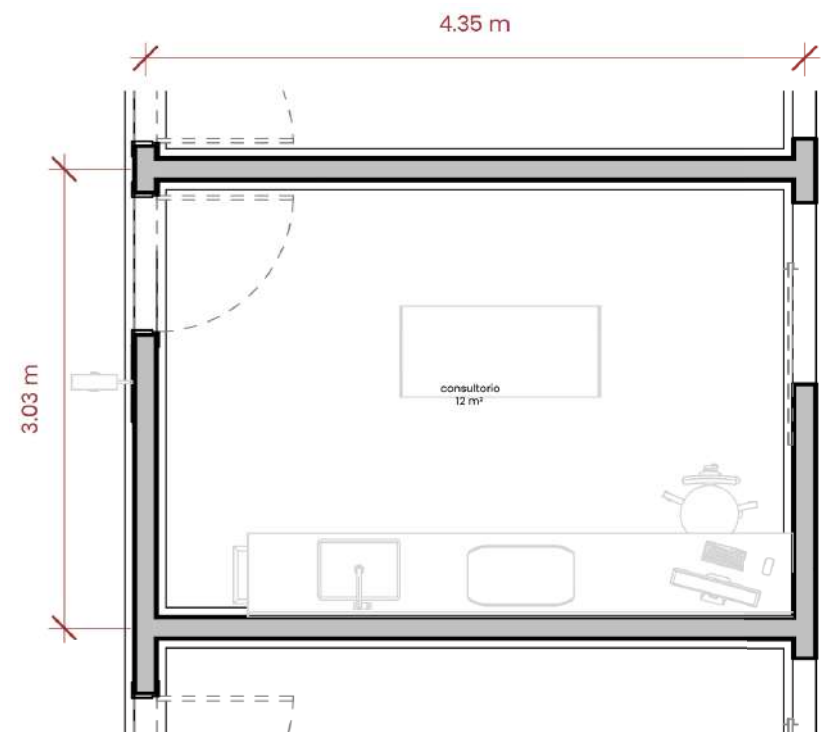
Detalle consultorio para gatos. Fuente: Elaboración propia
